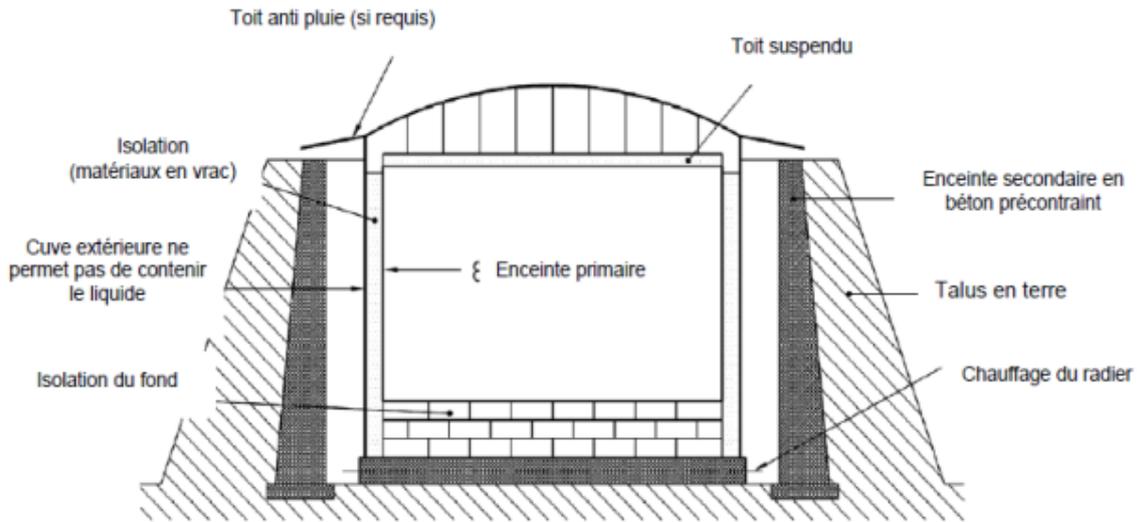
réservoir aérien à double intégrité construit sur une dalle béton chauffée à même le sol.
